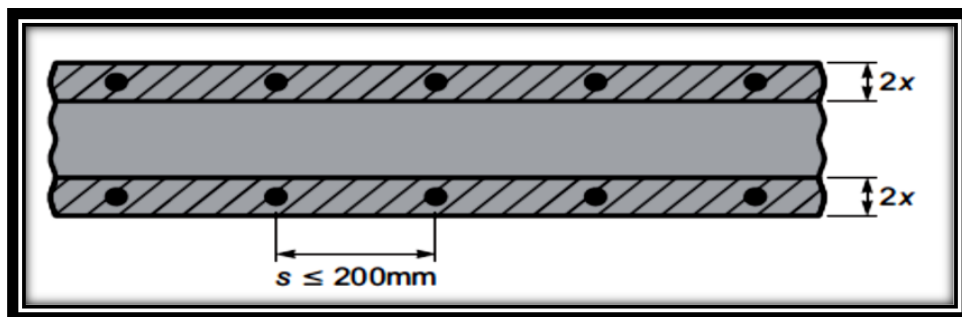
Armatures de peau d'une dalle unidirectionnelle
